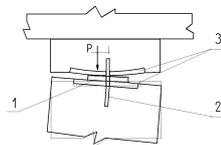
Шарнирное соединение (технический шарнир): 1-плитка, обеспечивающая зазор для поворота КФ; 2-связующий анкер; 3- закладные детали.
